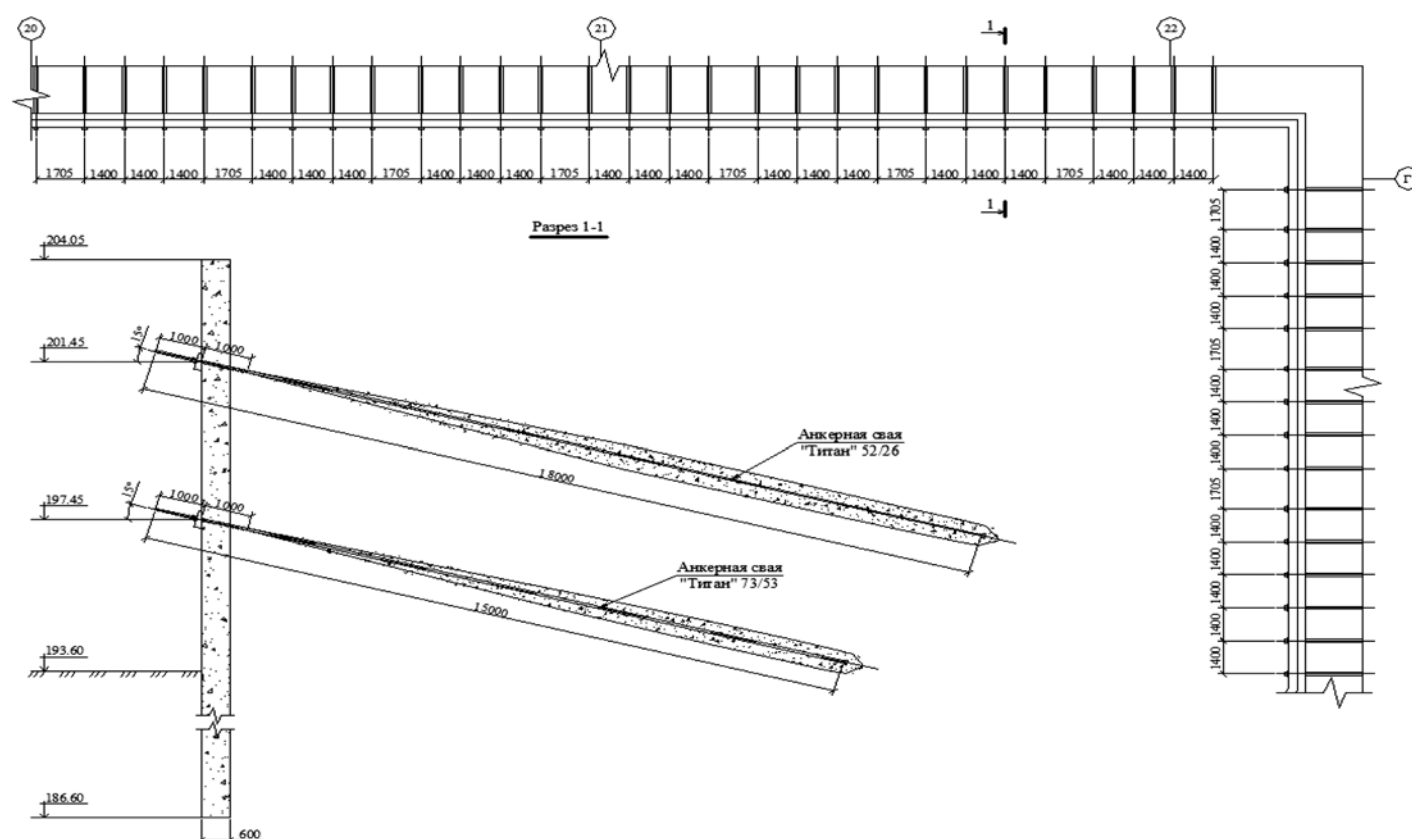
План и схема крепления анкерными сваями ограждения котлована при строительстве подземного терминала АВК-1
